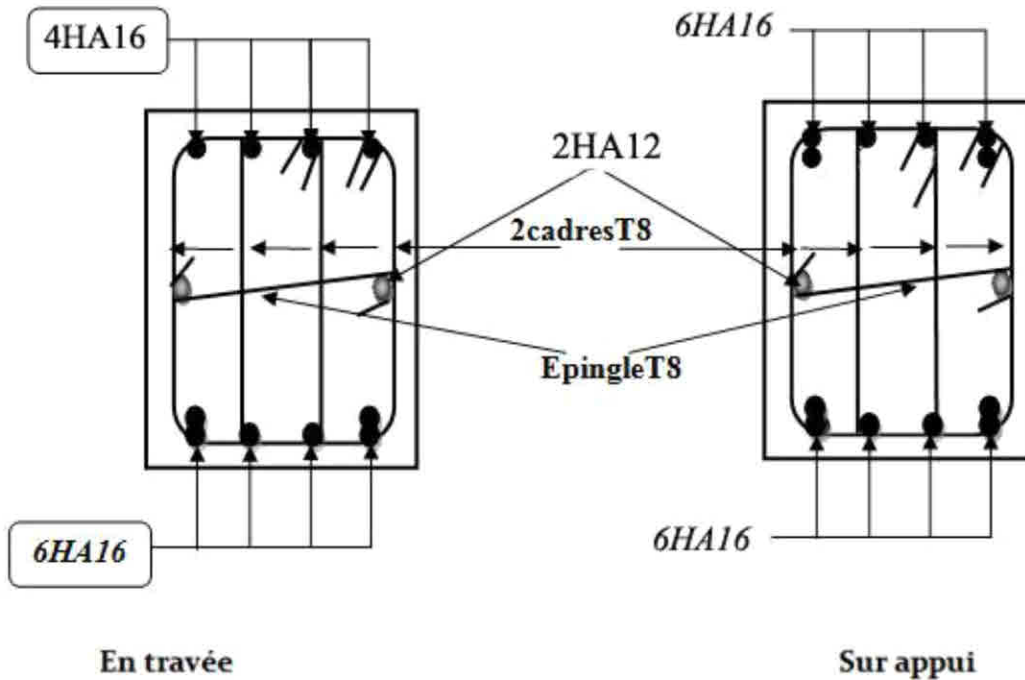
Schéma de ferrailage de la poutre 35x65
